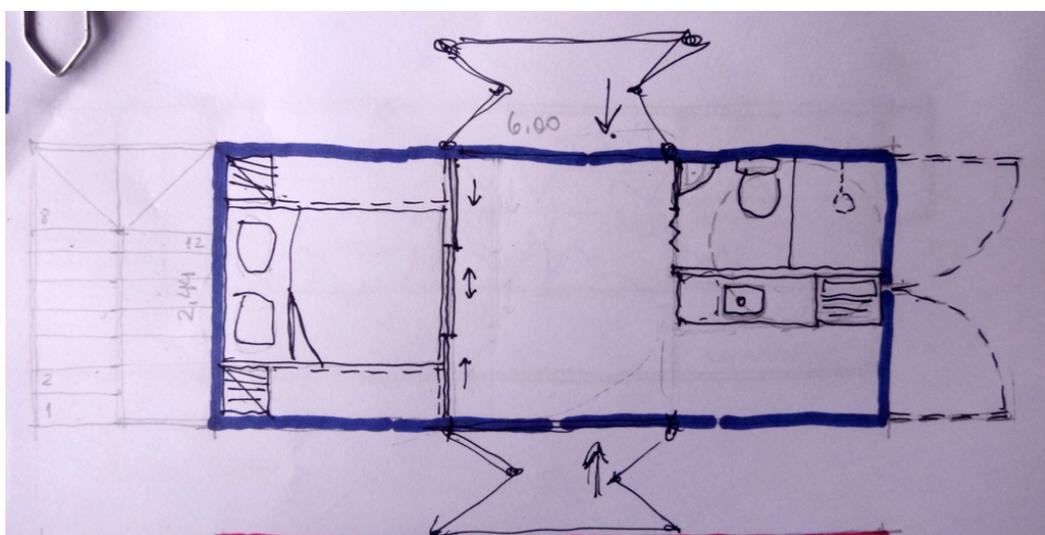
Croquis da planta baixa (EQUIPE 2)
